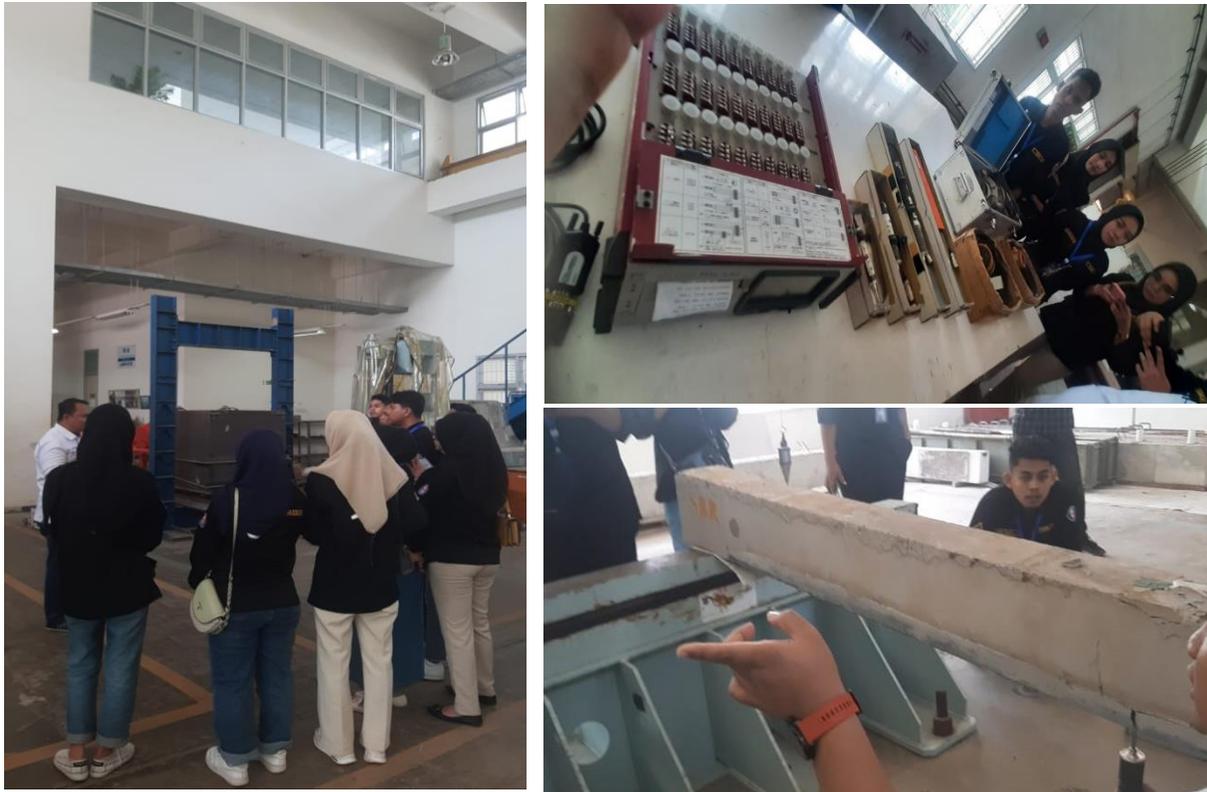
Ruang Laboratorium Struktur dan Bahan UNHAS
